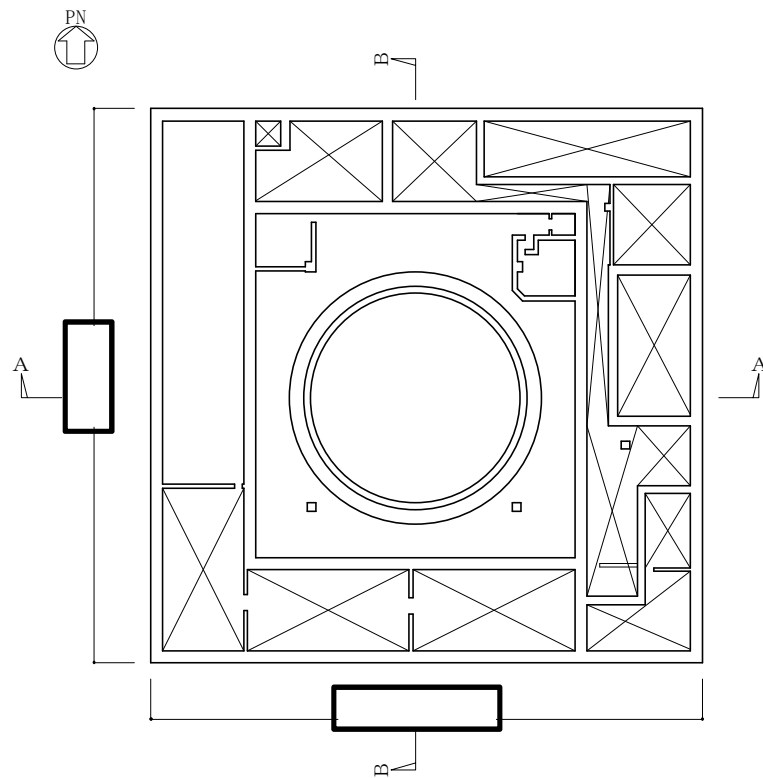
(2/10) 原子炉建屋の概略平面図 (EL. 2.0 m)
